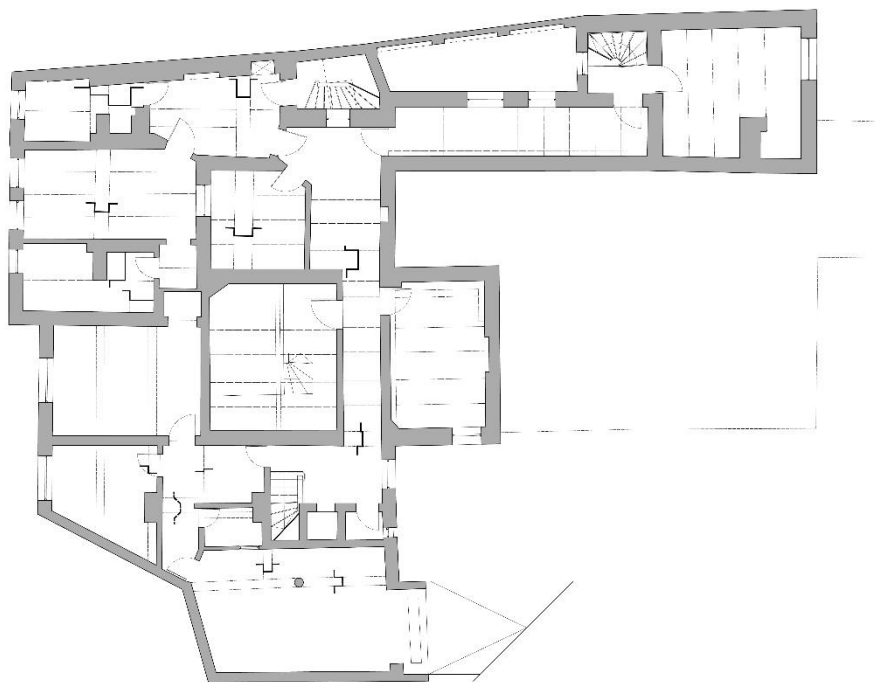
Releveul subsolului unei clădiri cu planșee din beton armat și din bolțișoare de cărămidă.
